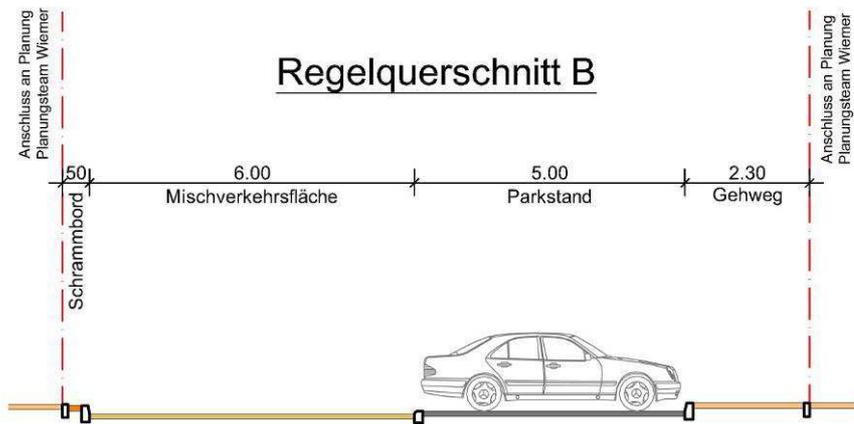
Querschnitt B - B in Planstraße B (Brilon Bondzio Weiser, Juli 2021)
